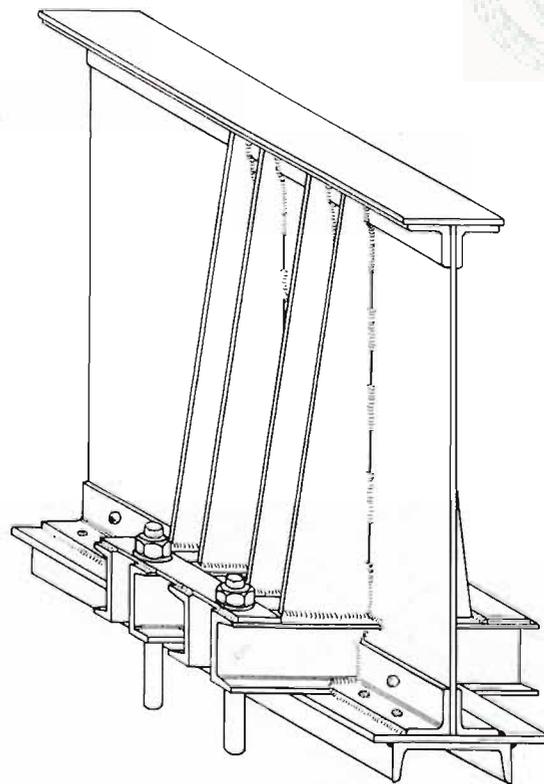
Renforcement de l'ancrage d'une maîtresse poutre du chevalement.
